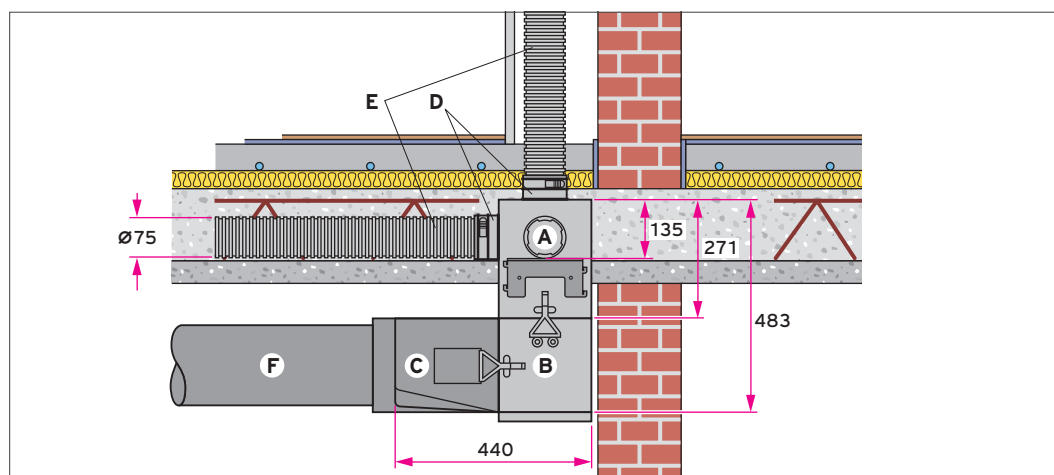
Luftverteiler/-sammler für runde Luftschläuche in der Rohbetondecke, Schnittdarstellung
